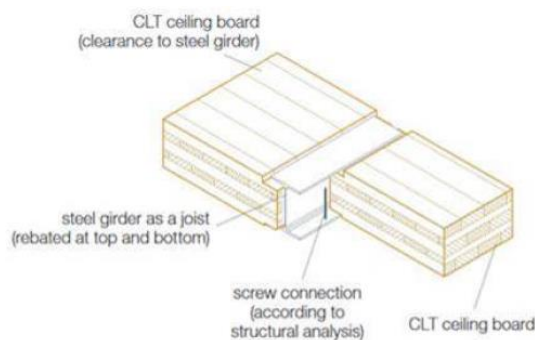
Ejemplo de enlace viga de acero - panel de CLT.
